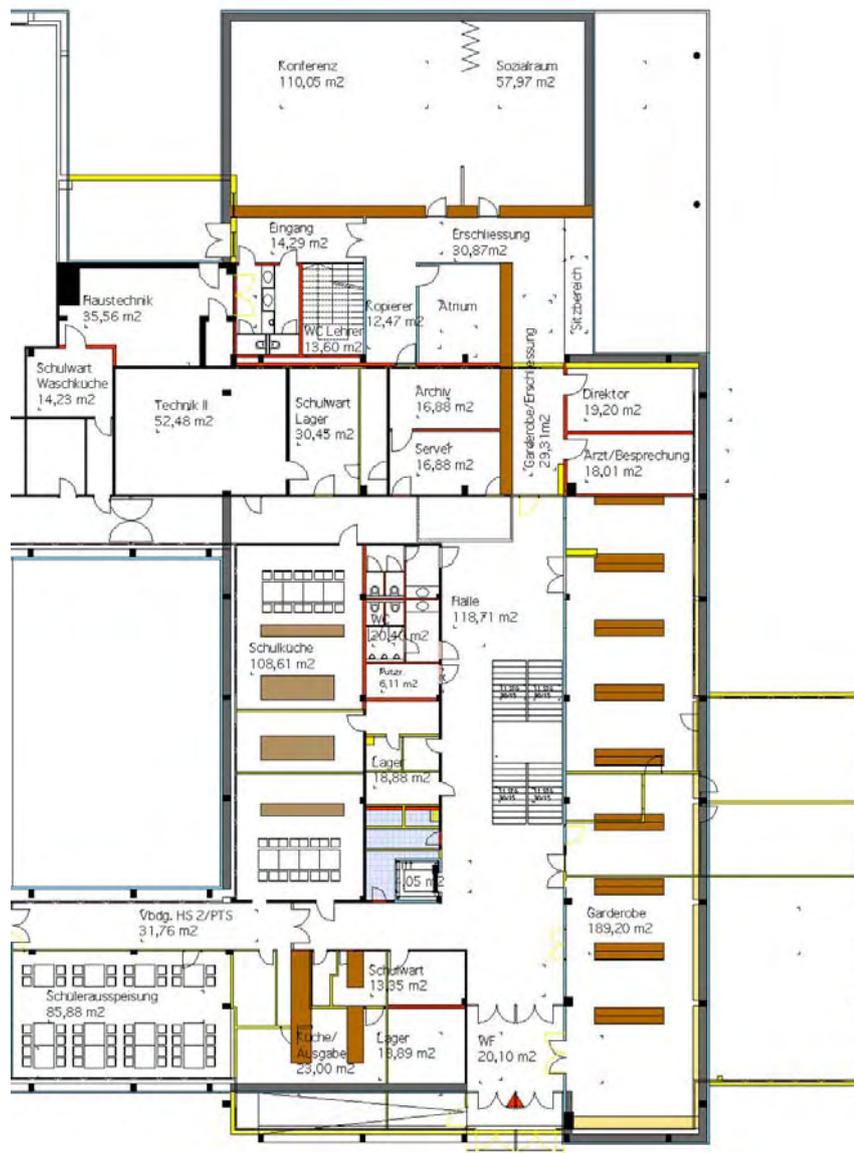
Schemaplan Grundriss HS II, EG
